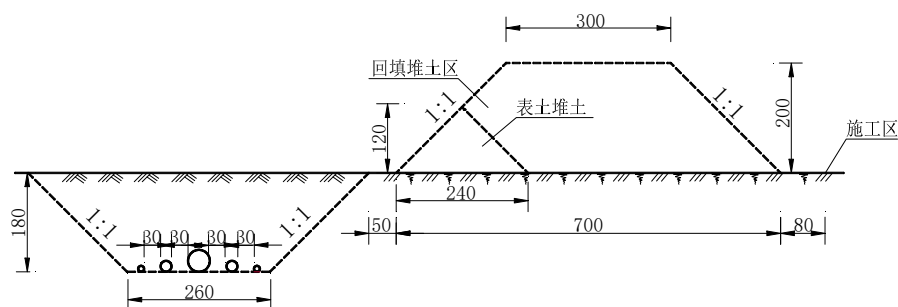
矿井工业场地至选煤厂供排水管线开挖断面图
